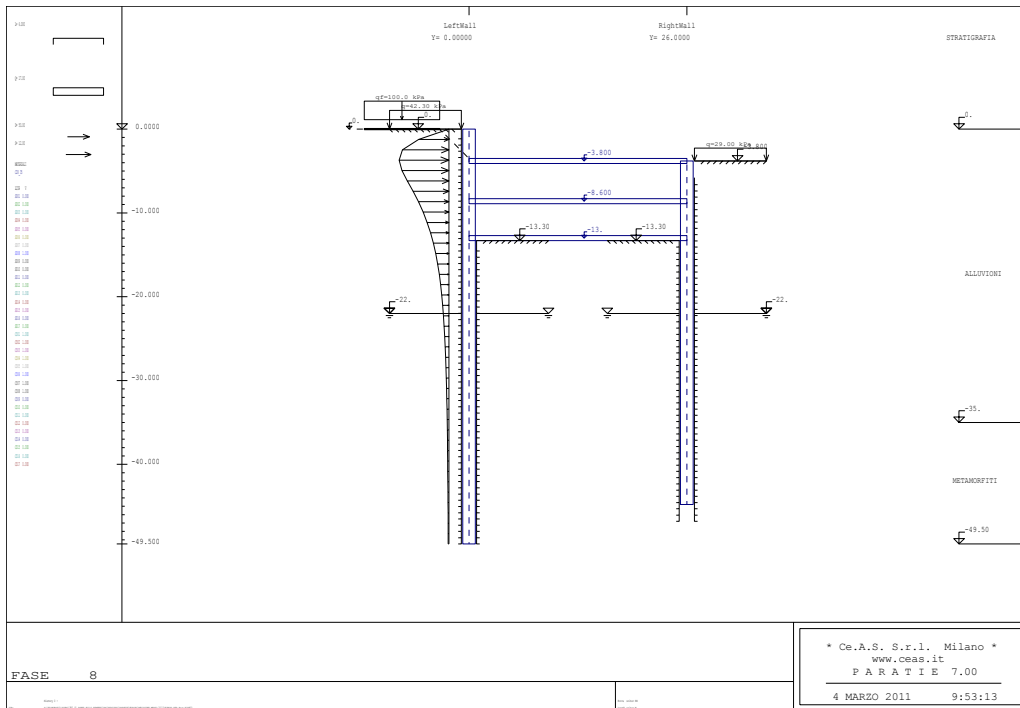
Fase 8: Getto Solaio +37.32m s.l.m.
